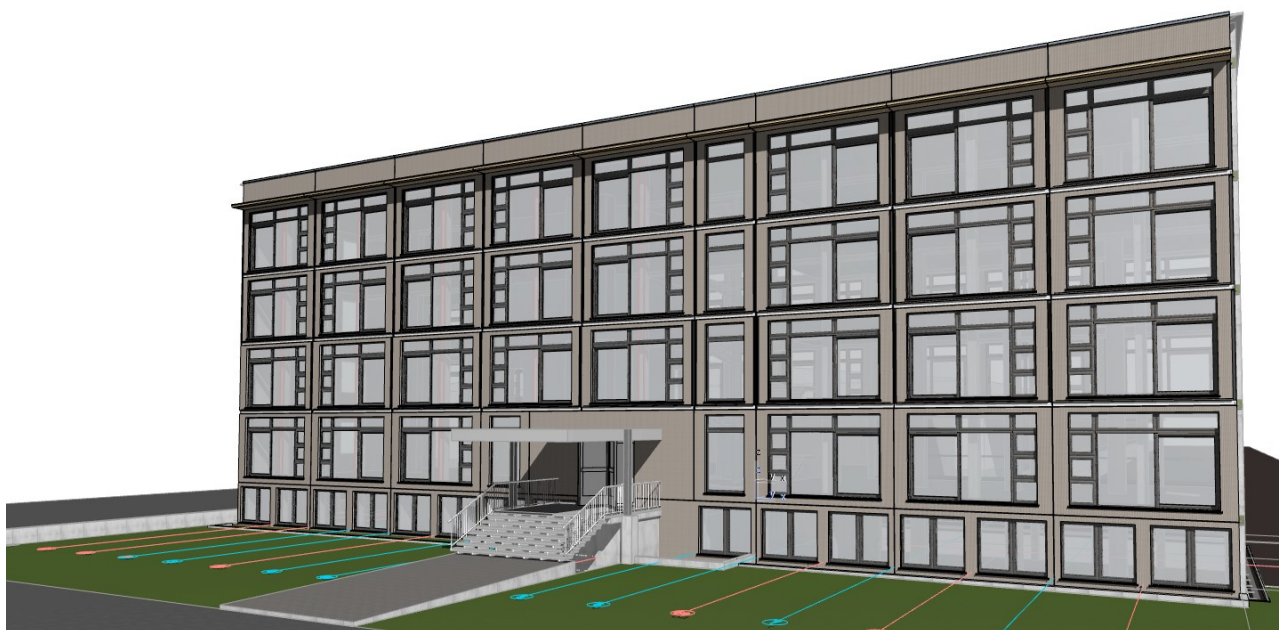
/ Aw 1a - Montage der Fassadenelemente
